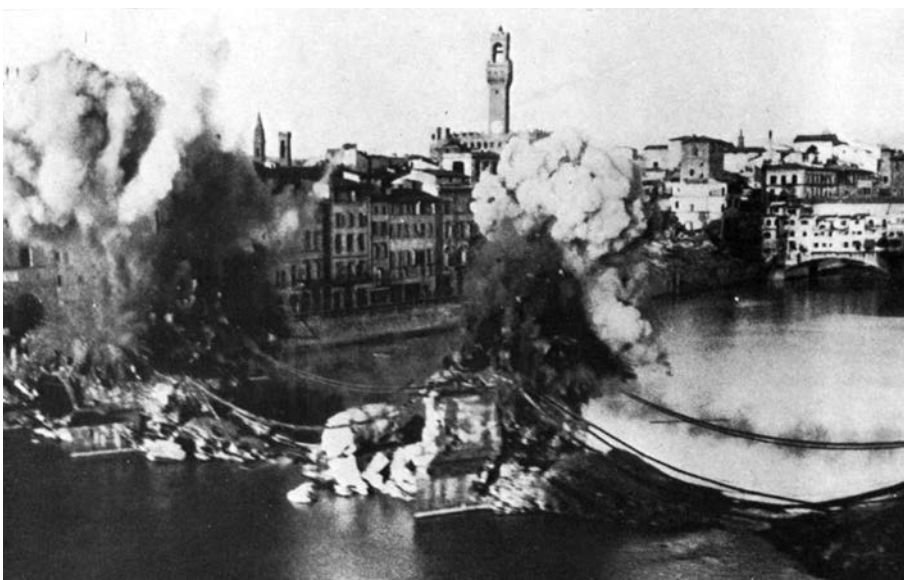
Il ponte A Santa Trinita distrutto dalle mine tedesche. La foto è di qualche giorno successiva al brillamento degli ordigni (che, tra l’altro, avvenne la notte). Le esplosioni nell’immagine sono dovute ad alcune cariche sistemate dalle truppe alleate per predisporre il piano di posa del successivo ponte Bailey che restò in opera fino alla definitiva ricostruzione.
